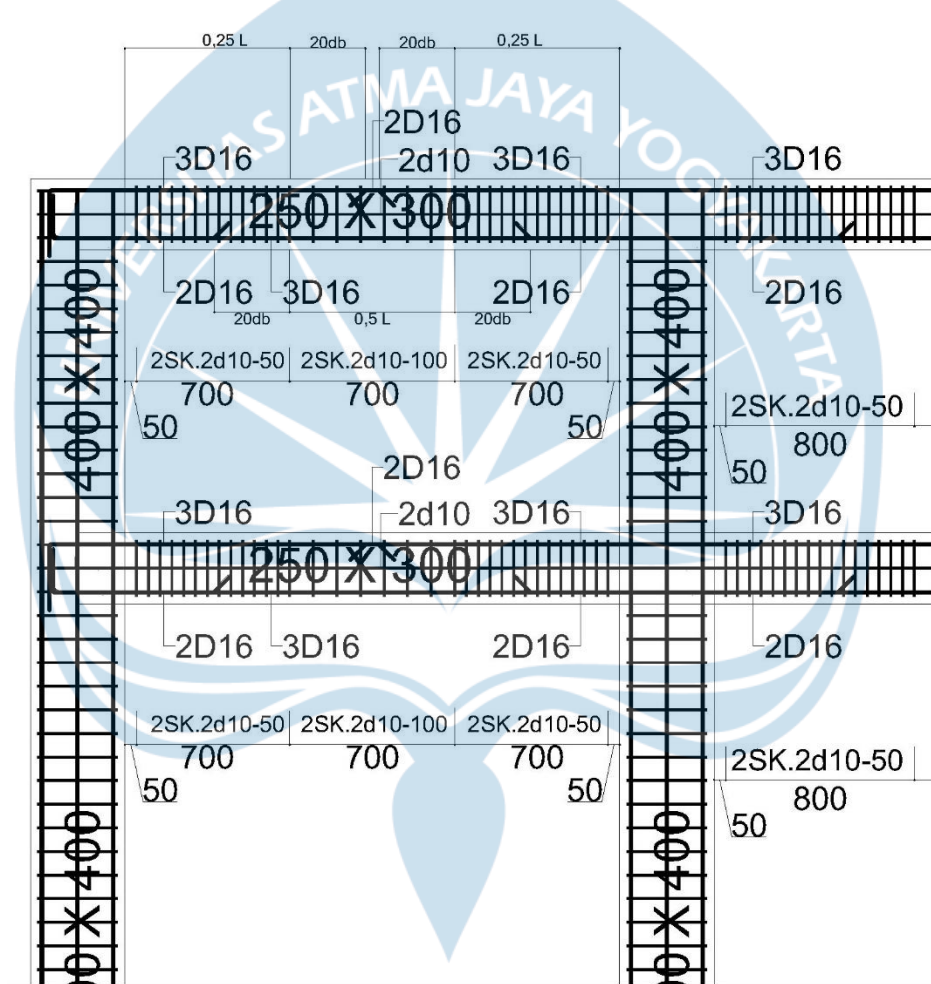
Detail penulangan balok lantai 2 dan 3 as B-C
